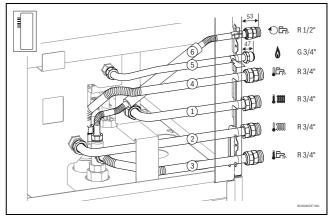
Vue côté arrière (dimensions en mm) : accessoire CS 10 FR-5300 monté sur le côté gauche
